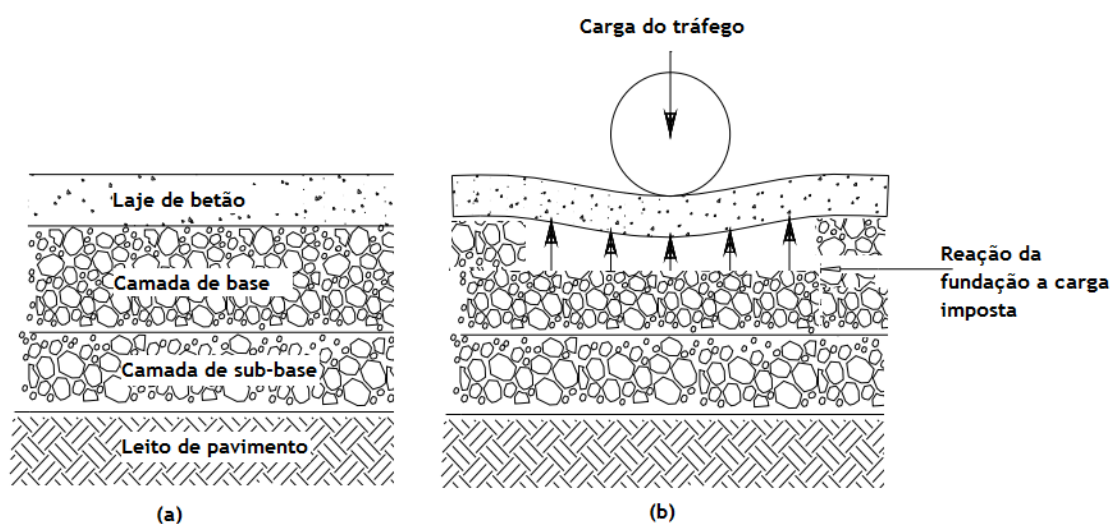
(a) Estrutura típica de pavimento rígido; (b) Distribuição da carga do tráfego num pavimento rígido (adaptado de AC 150/5380-6B, 2007).
